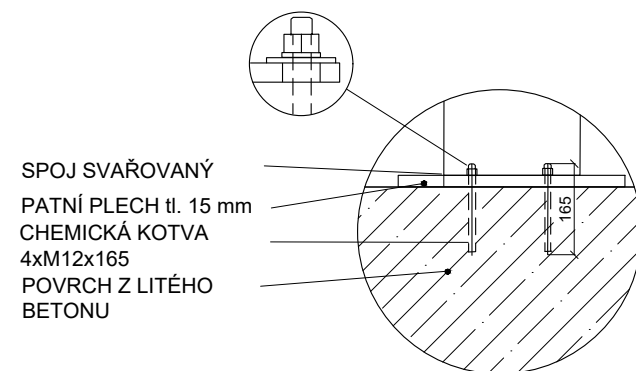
DETAIL KOTVENÍ ZASTŘEŠENÍ M 1:10
